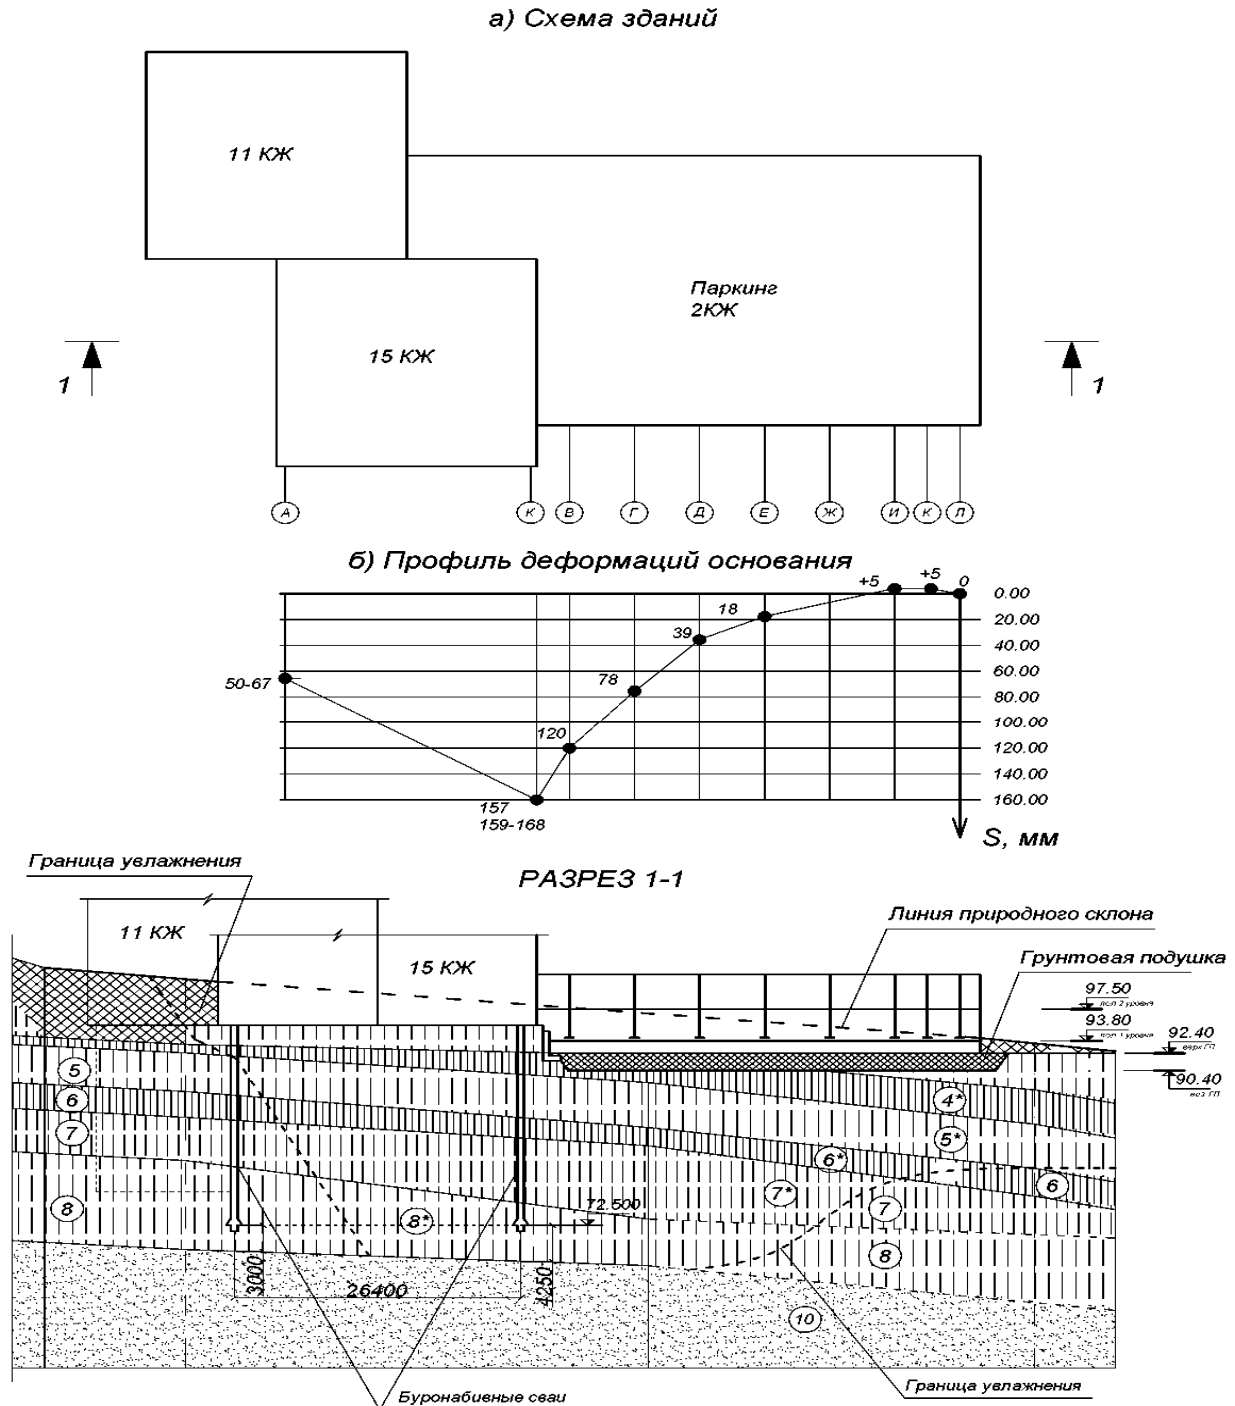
а – Схема размещения здания / Building spacing scheme ; б – Деформации основания и разрез строительной площадки / Footing deformation and geological section of building site ;
